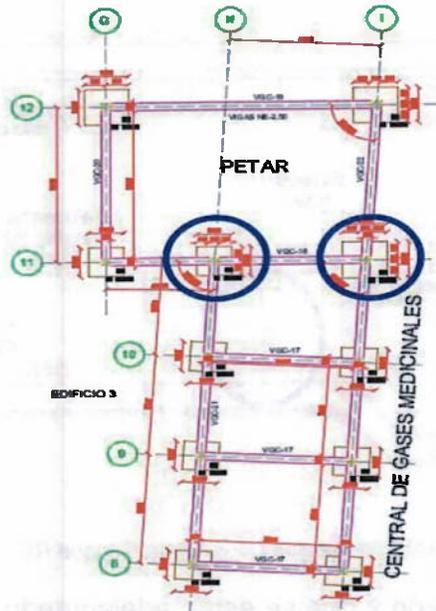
Planta de Cimentación Edificio 3 Lote B
